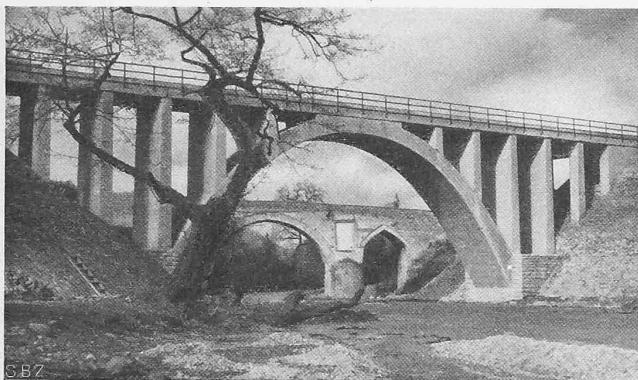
Eisenbetonbrücke über den Kharkhoun, Km. 146,7.
